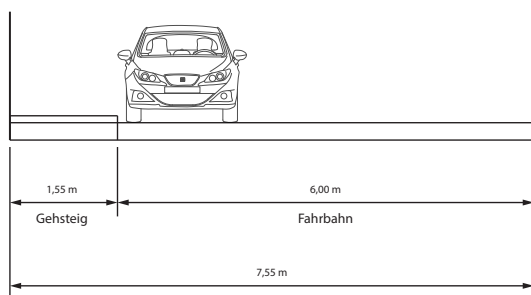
Schnitt Hochstraße. Quelle: eigene Darstellung
